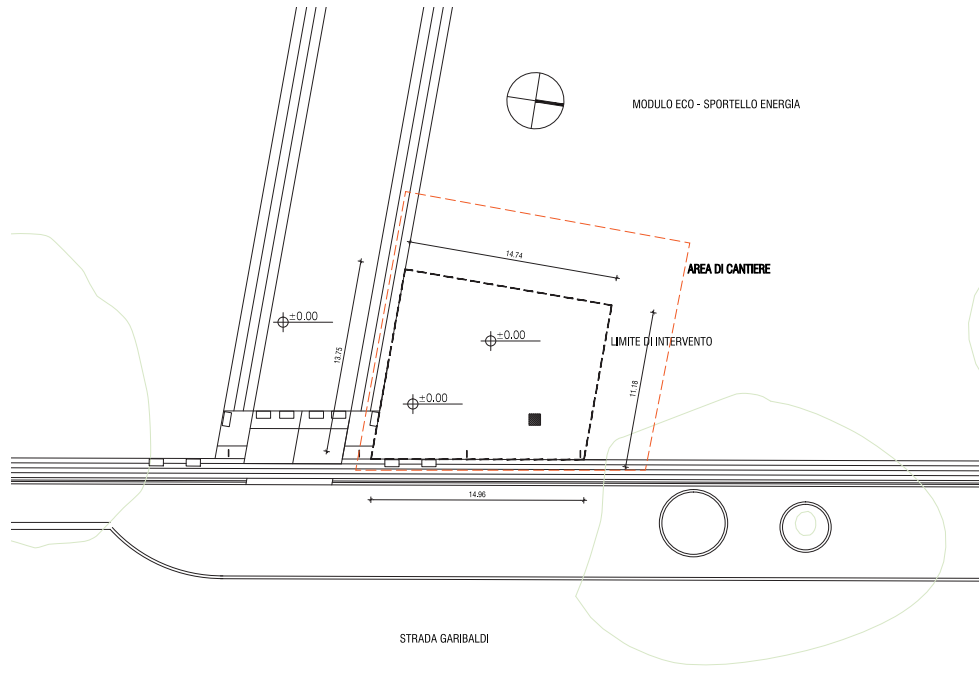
Planimetria con indicazioni riguardo il limite di intervento e l'area di cantiere.
